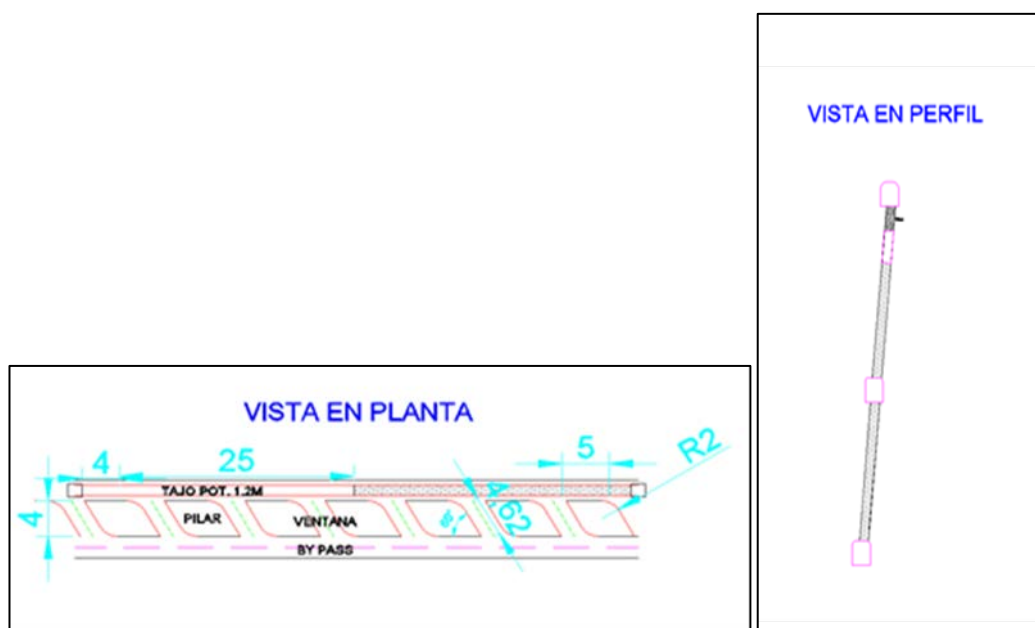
Vista en planta de la zona inferior y vista en perfil.
